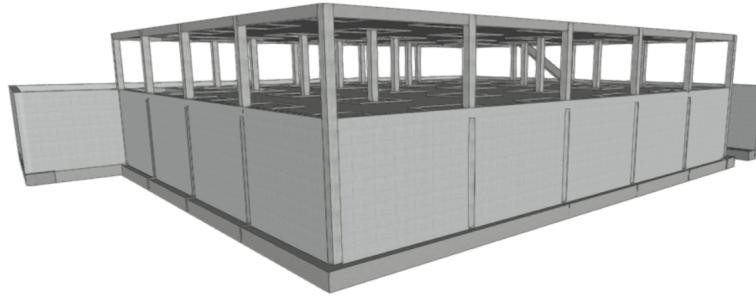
Representación 3D estructura de hormigón armado II. Fuente CYPECAD
